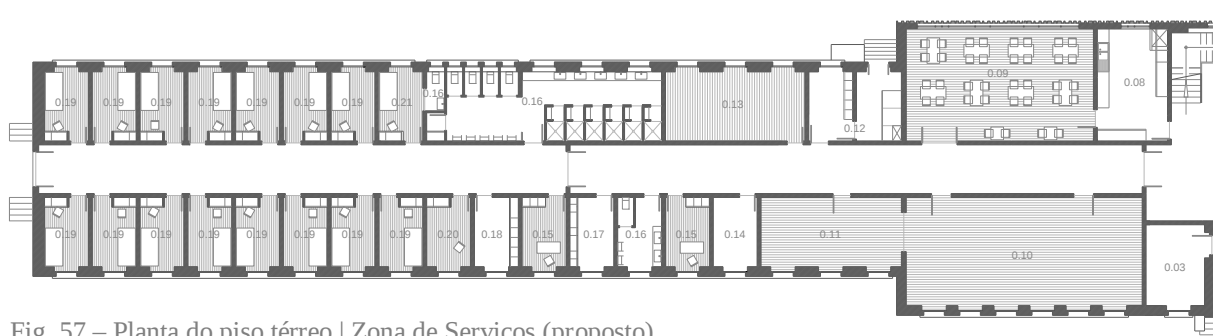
Planta do piso térreo | Zona de Serviços (proposto)
